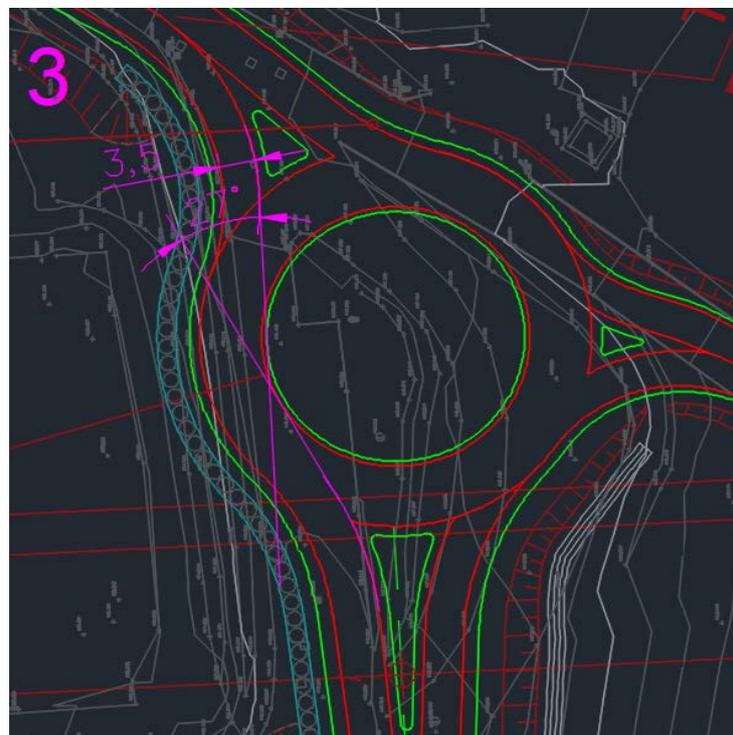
Rotatoria di collegamento alla S.P. 132 Varanese: angolo di deviazione braccio n. 2
